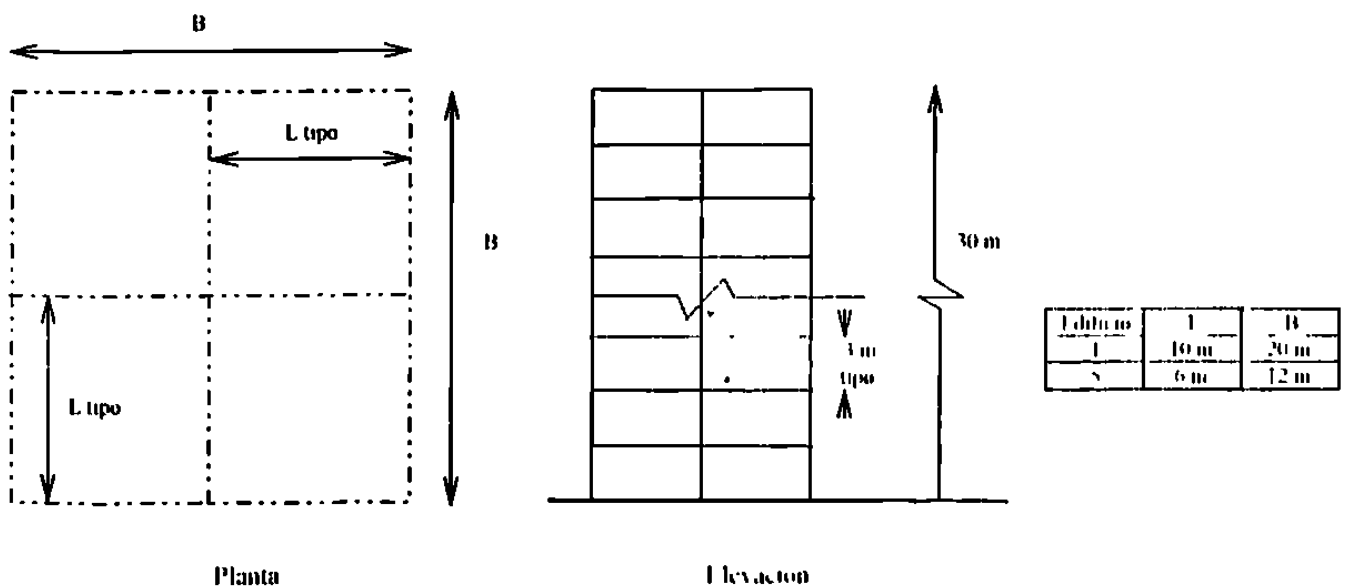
Planta y Elevación de los Edificios No. 1 y 5
